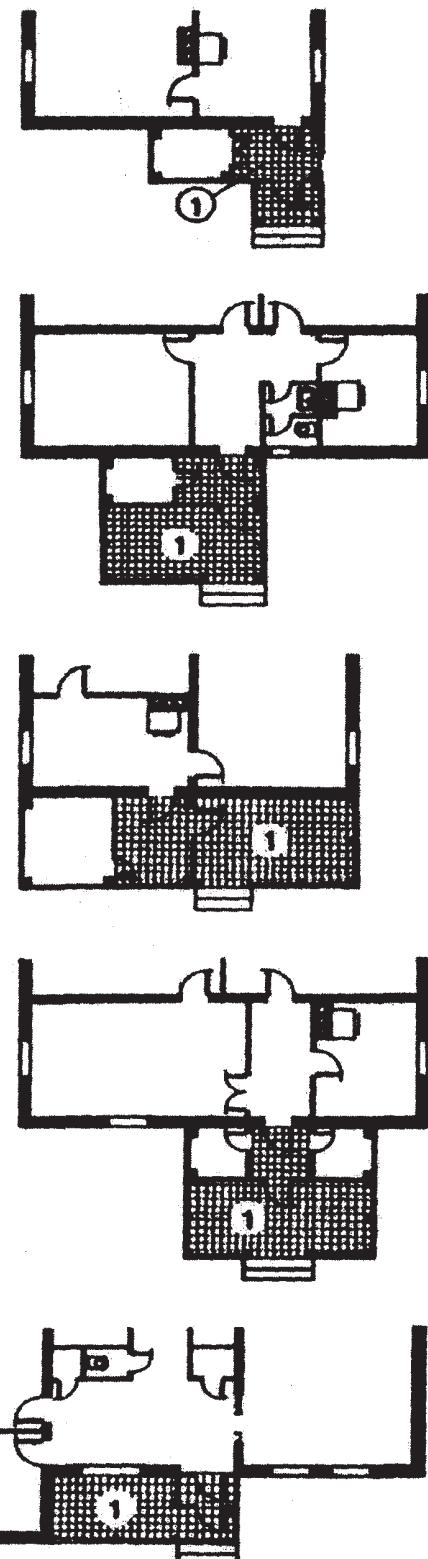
Планировочные схемы входных узлов малоэтажных жилых зданий
